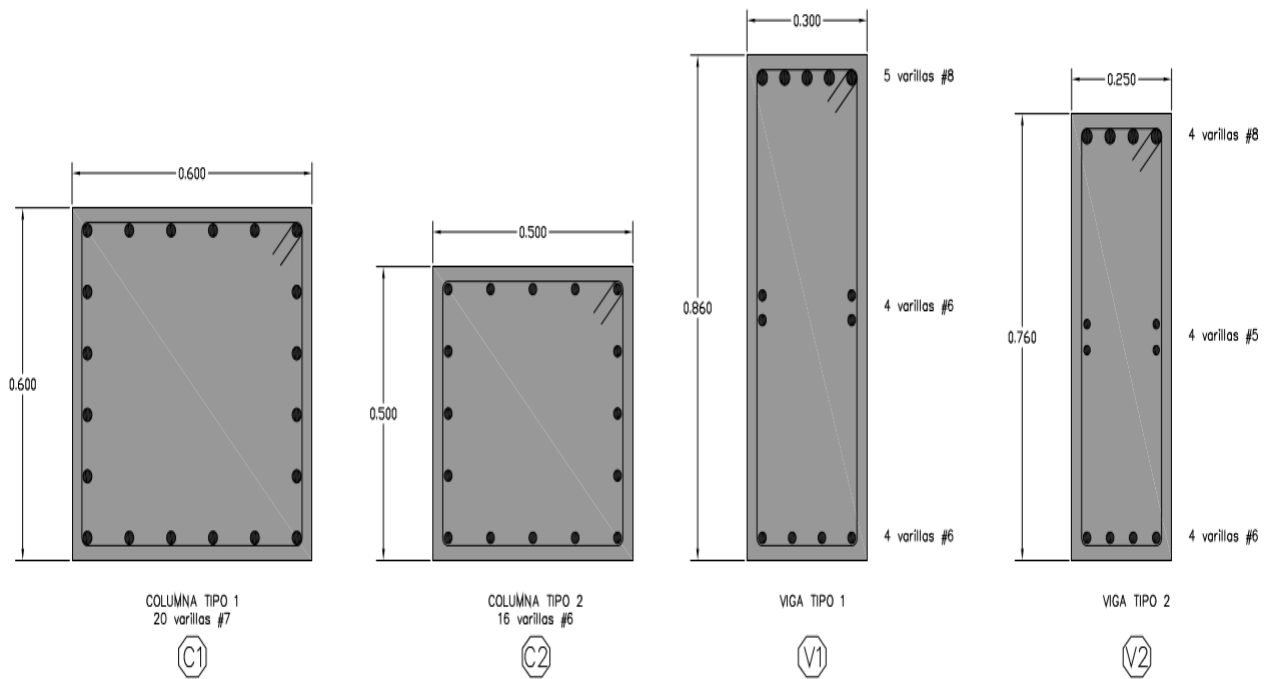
Detalles constructivos para el edificio de 8 niveles
